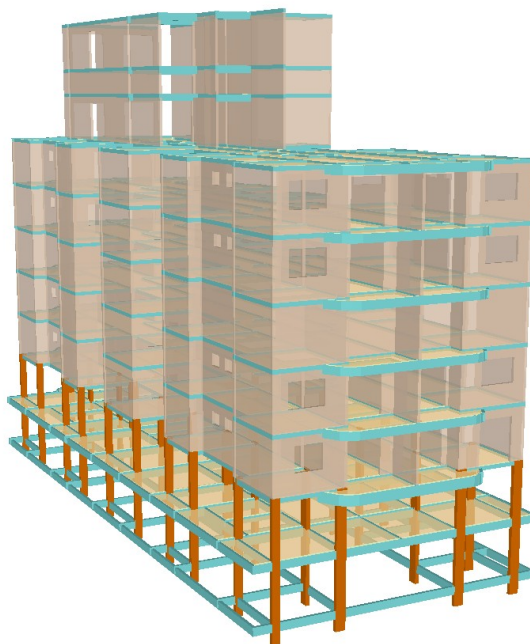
Edifício em alvenaria estrutural apoiado em pavimento pilotis em concreto armado.
